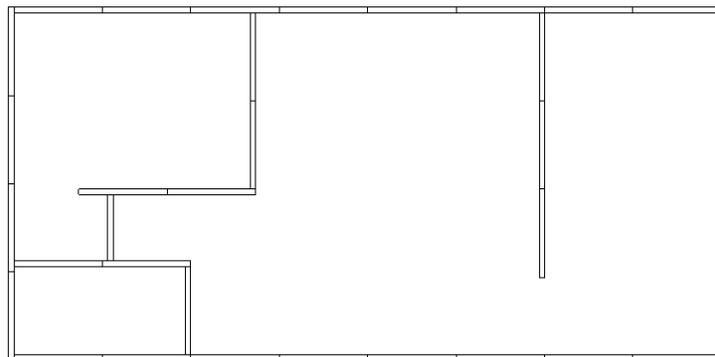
Esquema disposición paneles de muro. Fuente: Elaboración propia.
